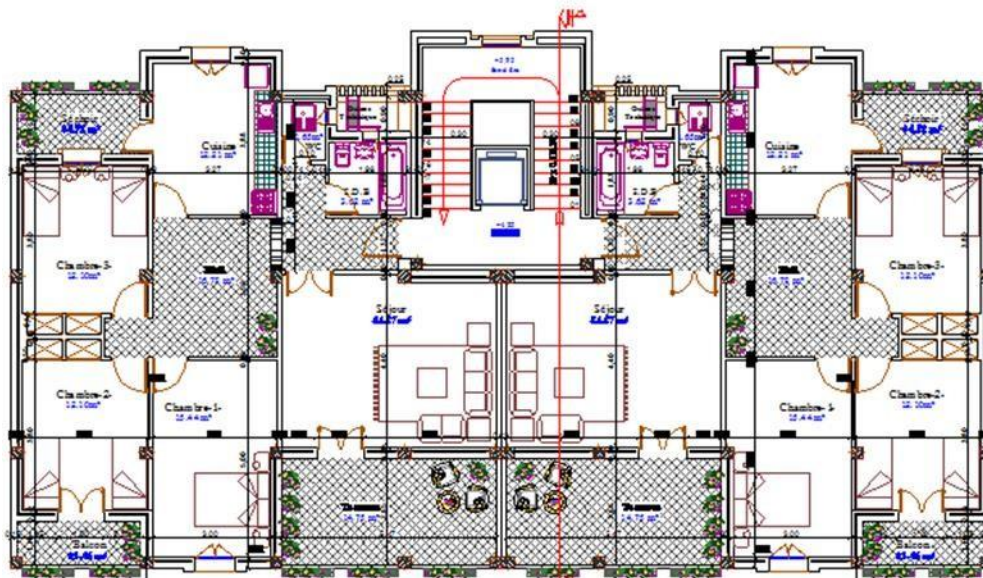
Plan du 1<sup>er</sup> étage, source : auteur
